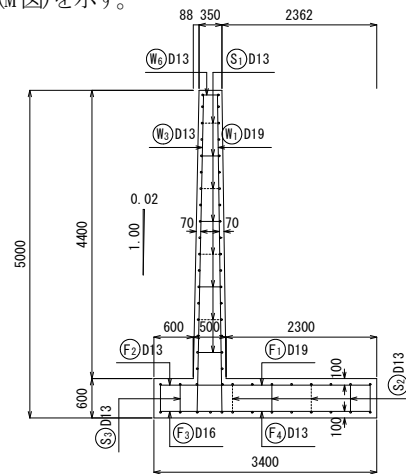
既設逆 T 型擁壁の配筋図 (断面図)
